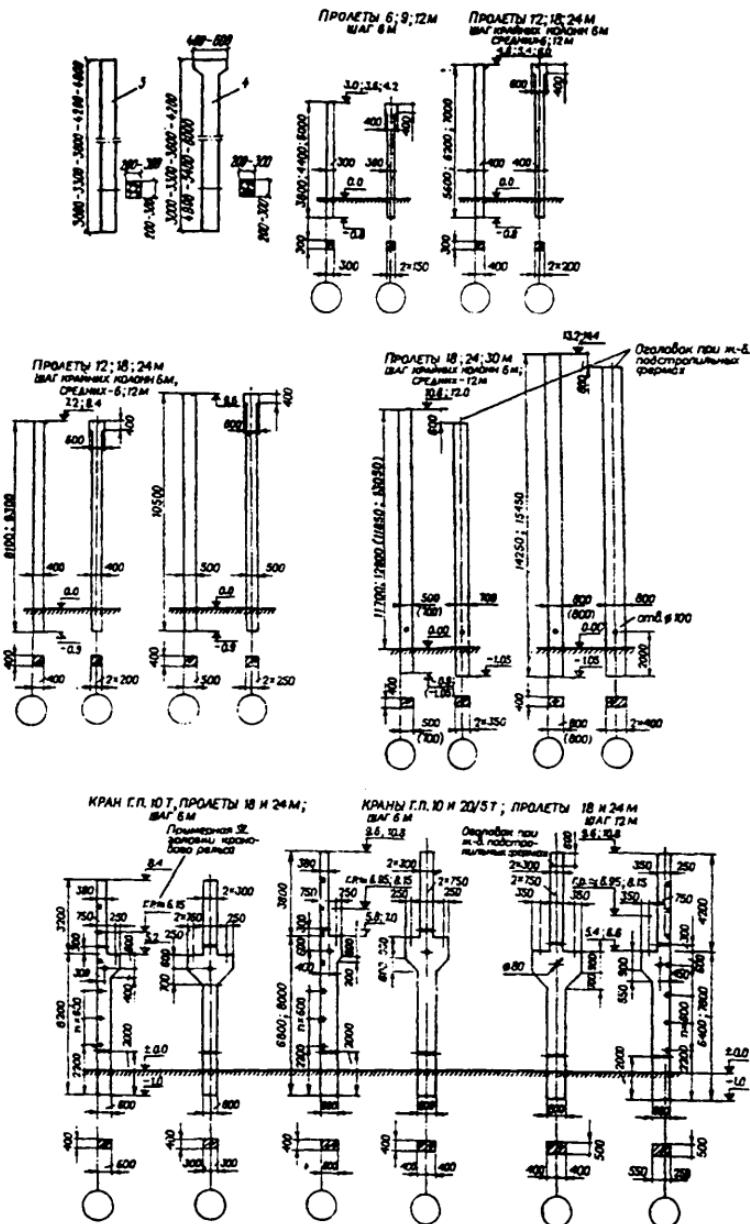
Железобетонные колонны прямоугольного сечения для зданий без мостовых кранов высотой 3,0–9,6 м и 10,8–14,4 м с кранами грузоподъемностью 10; 20/5 т
